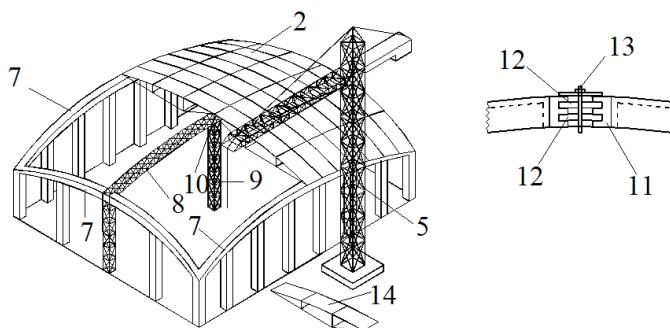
Схема монтажа оболочки гауссовой кривизны с предварительным укрупнением и установкой временных опор:
